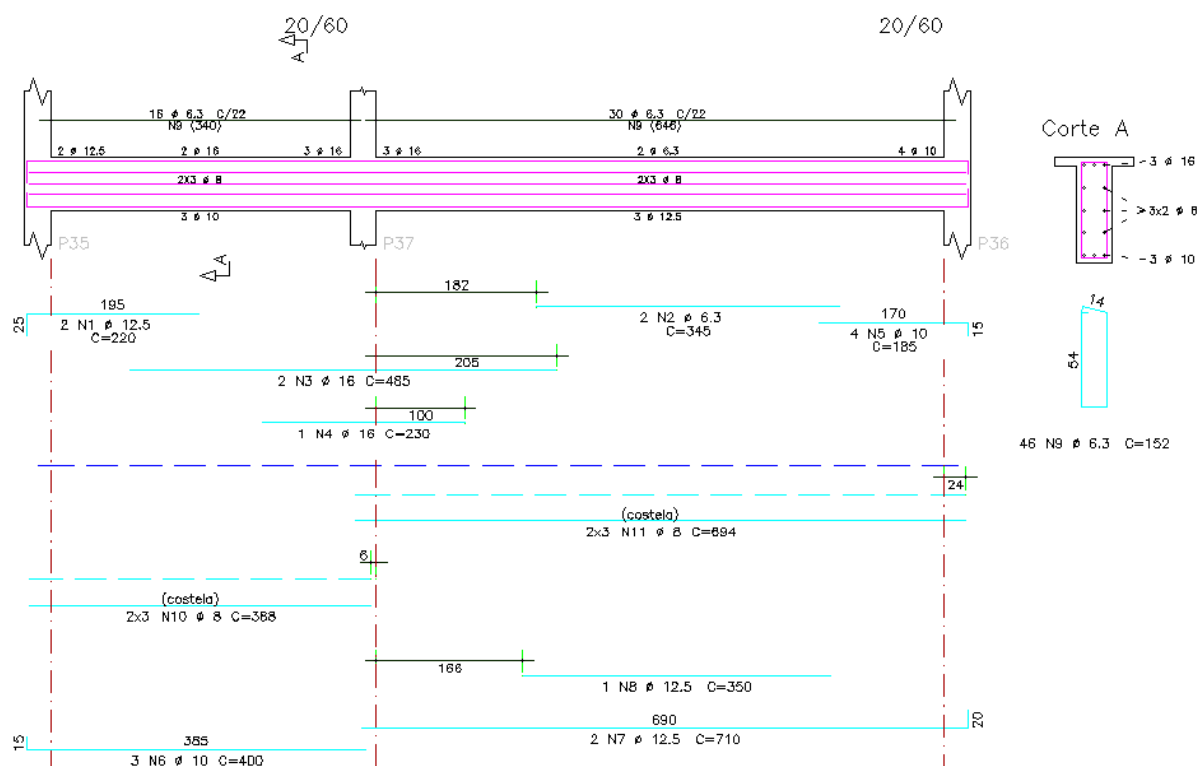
Armaduras da viga V12 do pavimento Biblioteca da Solução com Laje Nervurada
